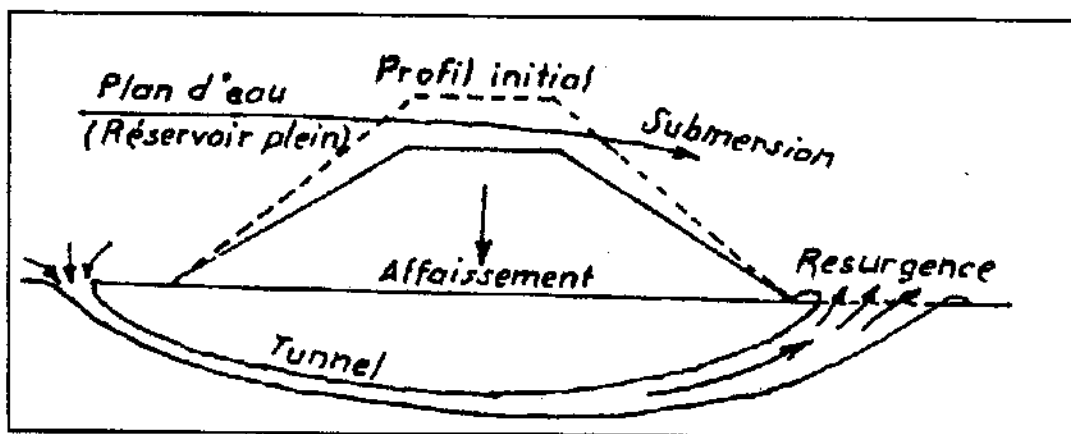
Affaissement et submersion d'un barrage en terre miné par un renard.
